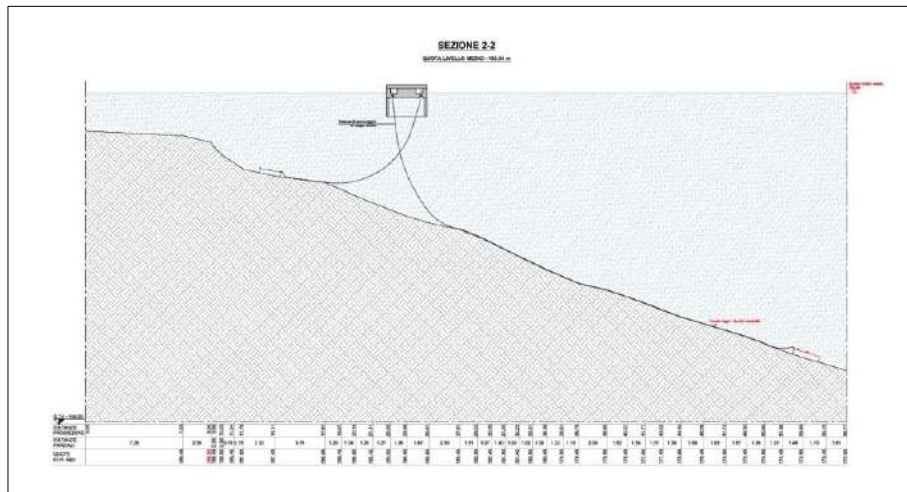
Ranco – Diga di protezione posta all’imboccatura del preesistente porto
